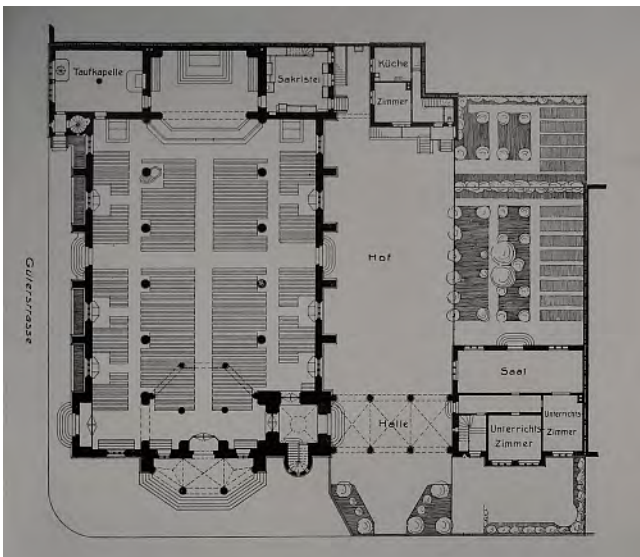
Basel, Heiliggeistkirche (Meckel/Doppler 1911–12). Grundriss der gesamten Anlage. Kirche, Pfarrhaus (unten rechts) und Sakristanshaus neben der Sakristei gruppieren sich um einen Innenhof. – Ews Heiliggeist Basel 1912, 23.
